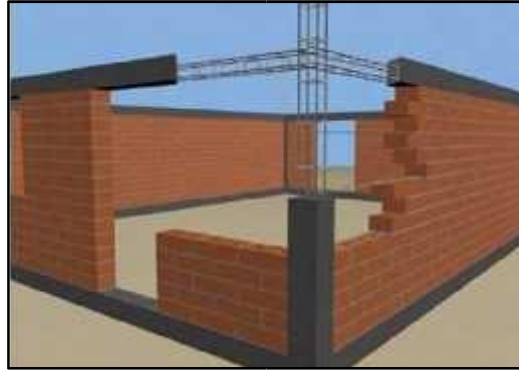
Construcción de Muros de Albañilería y Elementos de Arriostre.
